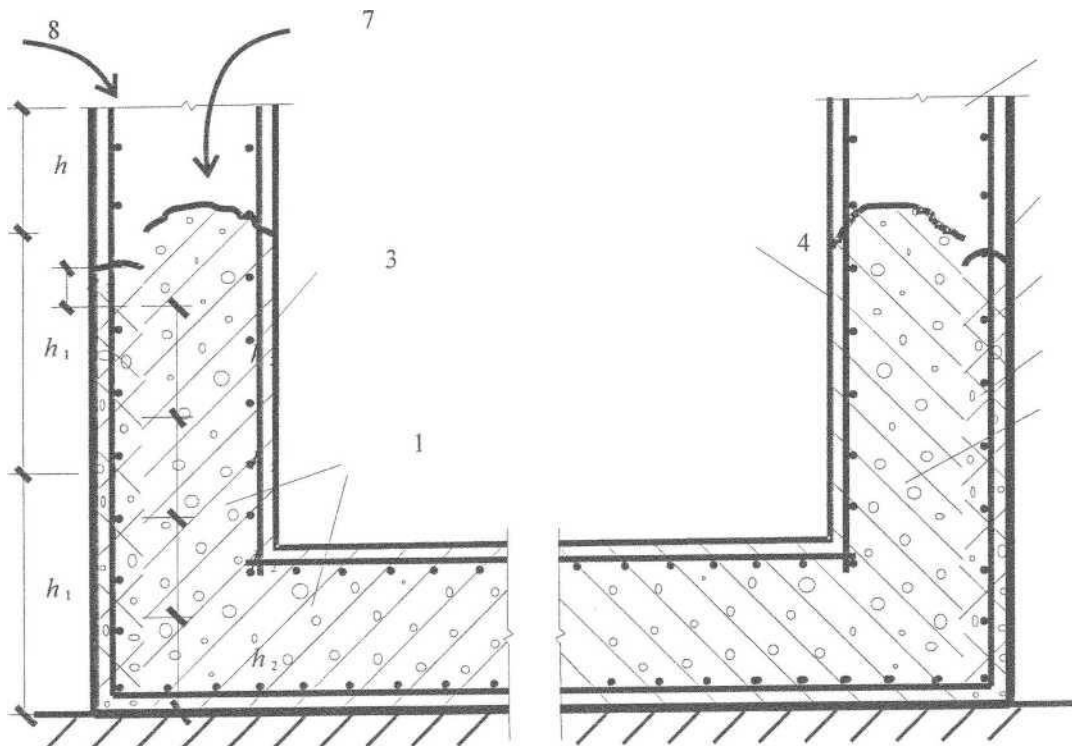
Схема бетонування спеціальних залізобетонних споруд
